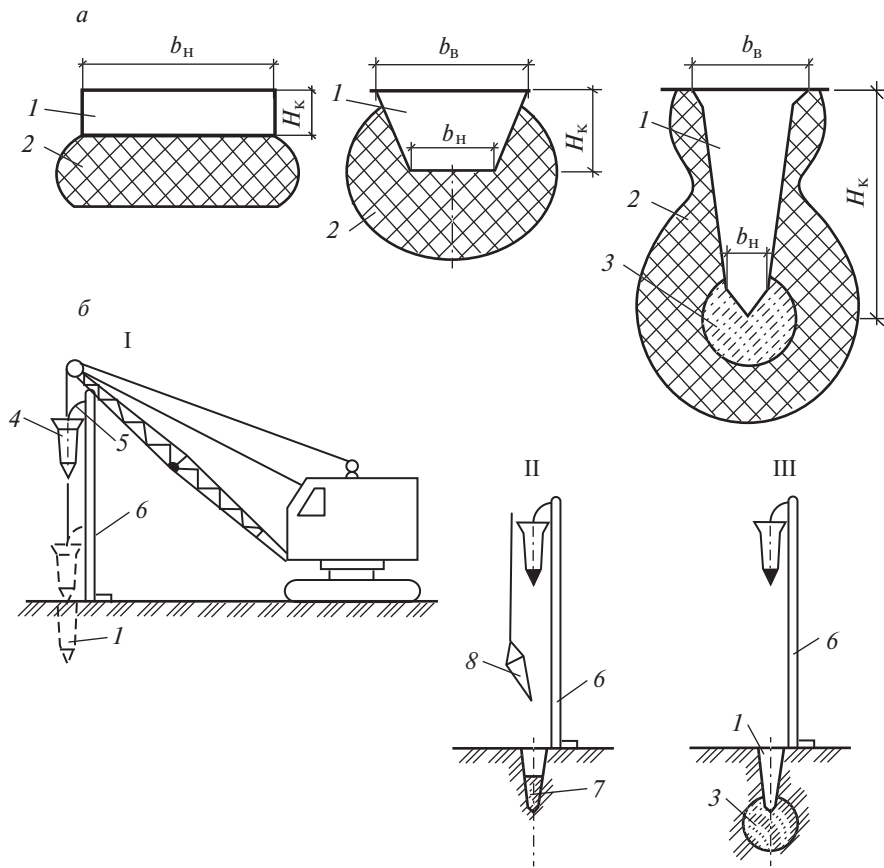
Схемы устройства методом вытрамбовывания котлованов фундаментов (<https://studfiles.net>, 2015):
